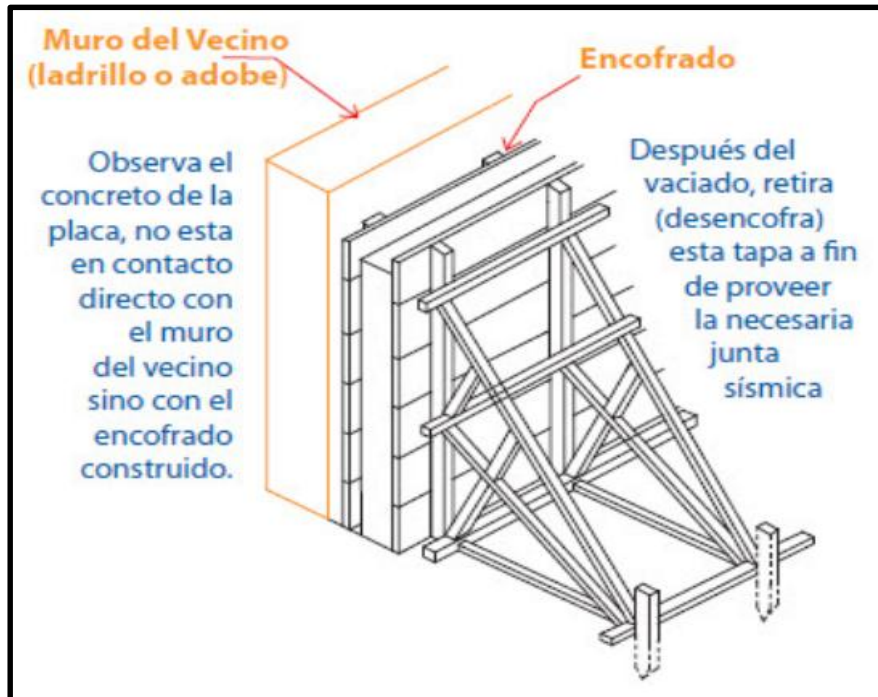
Placa de concreto armado colindante con el muro vecino. Fuente: Aceros Arequipa.
